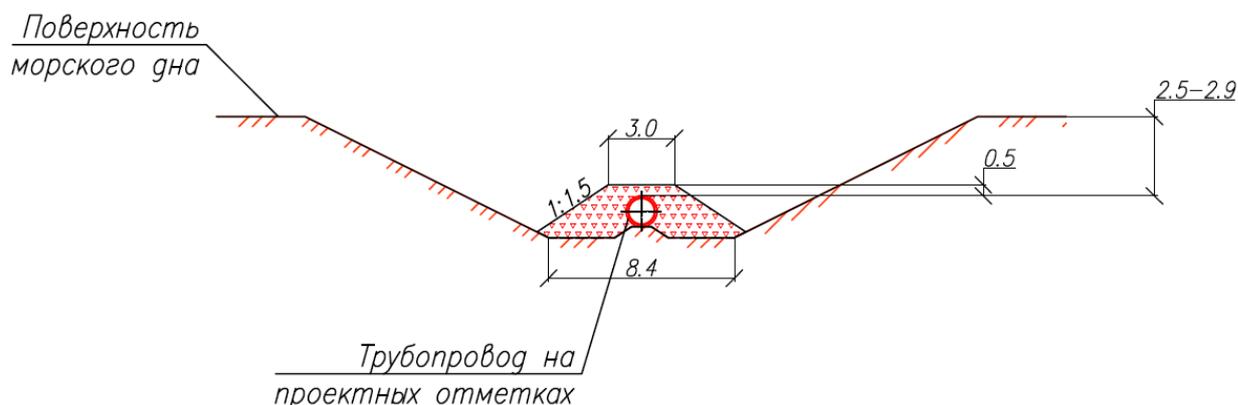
Разработка грунта самоотвозным землесосным снарядом и гидроразмывной установкой
